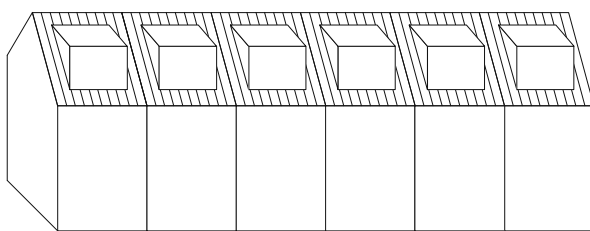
Bei einer gleichmäßigen Anordnung der Dachgauben wirkt das Gebäude ruhiger.
